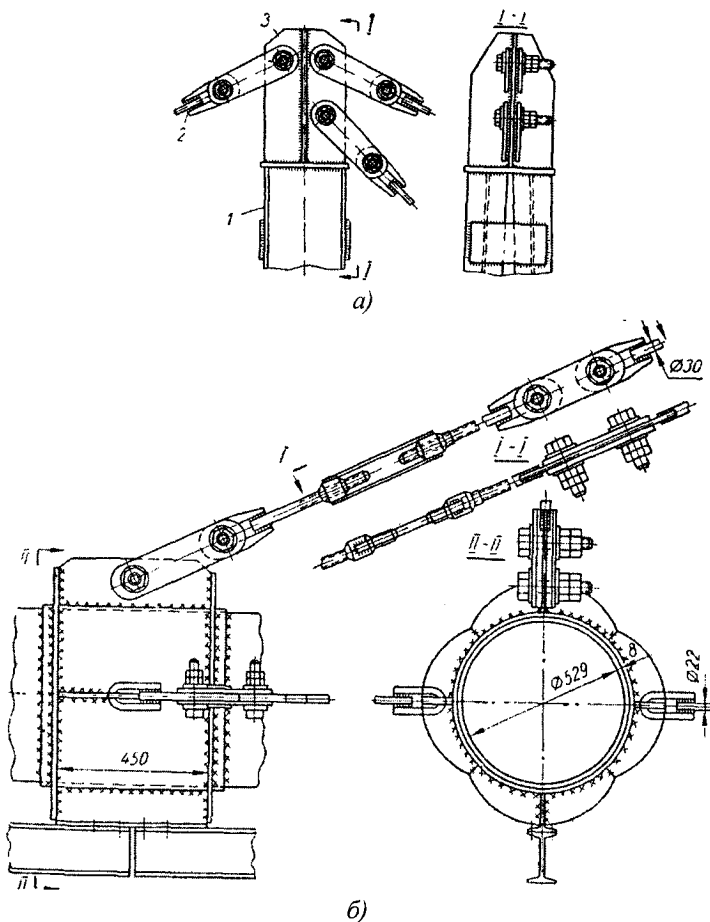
Кріплення вантів з круглої сталі: а – до пілона; б – до труби; 1 – пілон; 2 – ванти; 3 – оголовок з листової сталі
